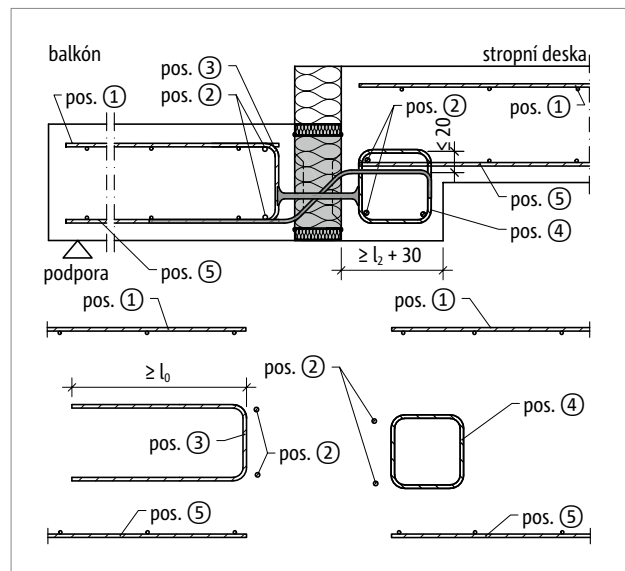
Schöck Isokorb® T typ QPN-V9 až V14: Napojovací stavební výztuž s filigránovou výztuží
